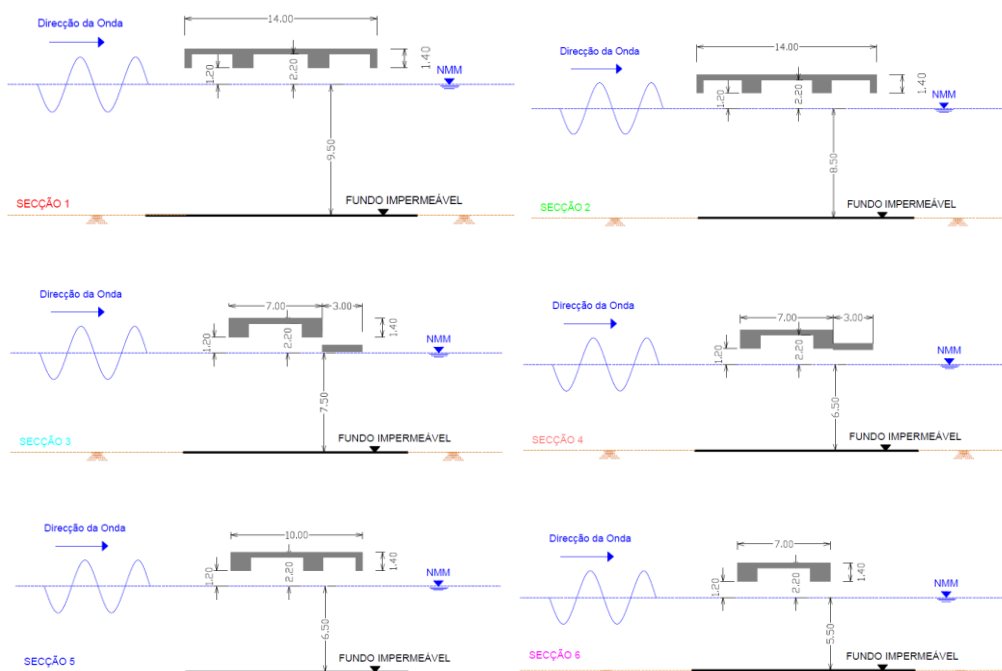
Secções transversais da ponte-cais: Secção 1 a Secção 6.
